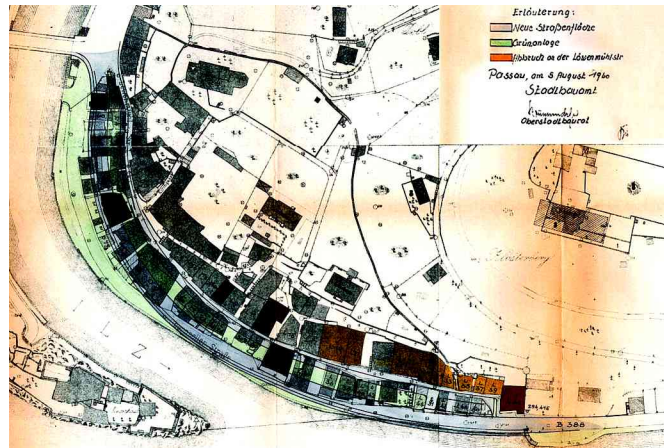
Passau. Plan zur Sanierung der Ilzstadt von 1960.
